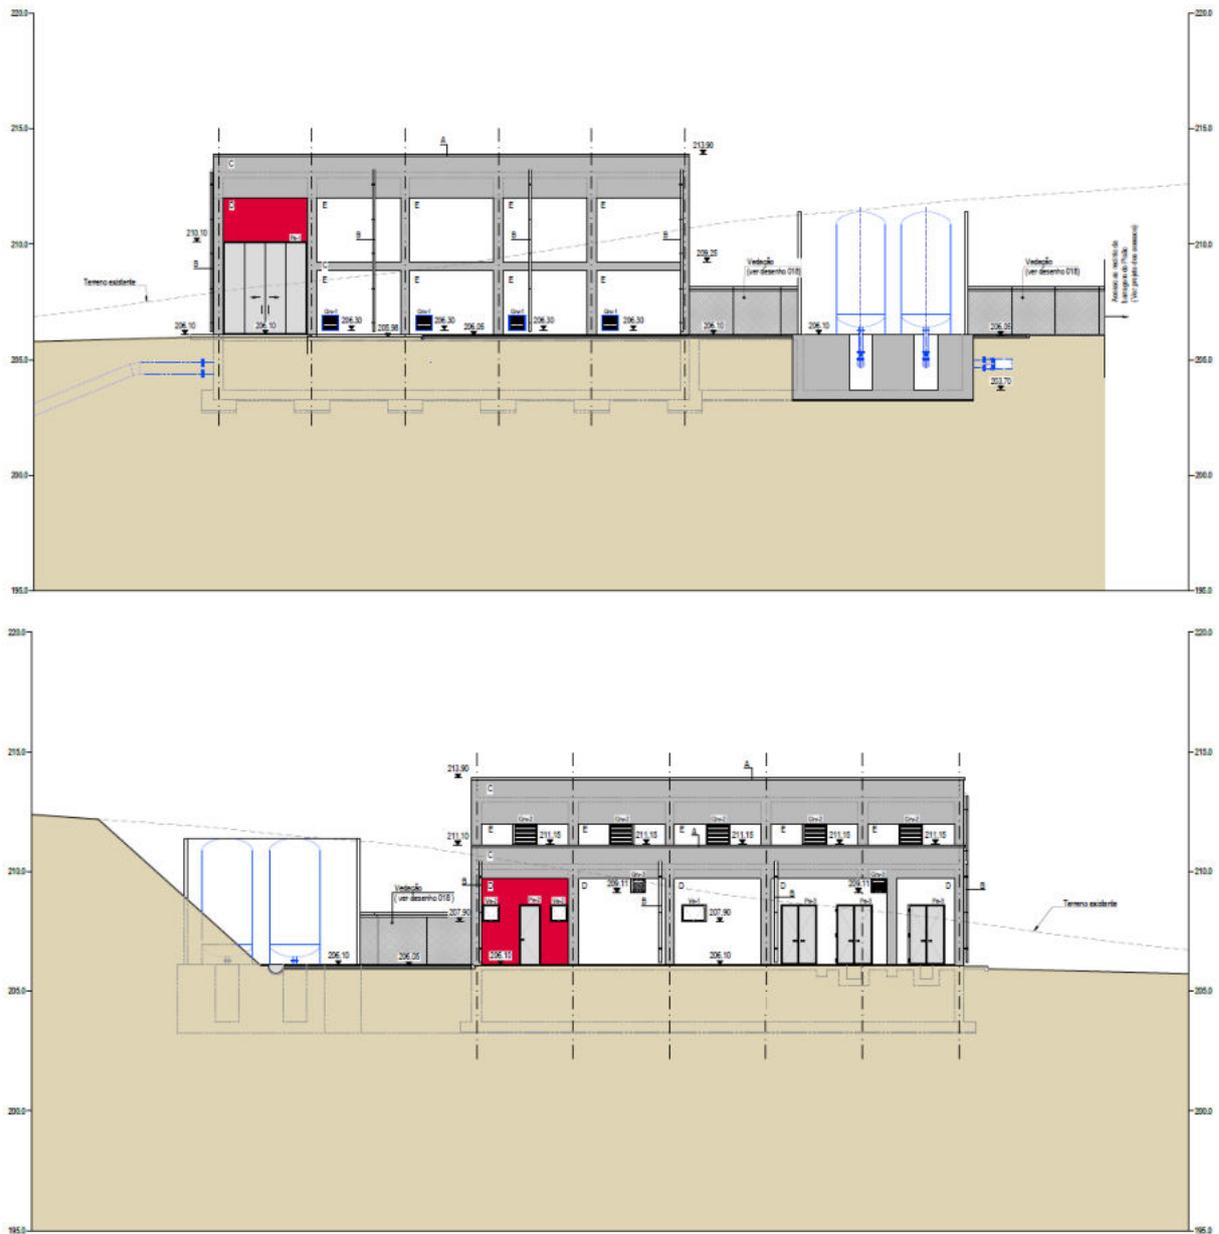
Alçados da Estação Elevatória de reforço de abastecimento de água à ETA da Póvoa. alçado principal (em cima), alçado posterior (em baixo).
